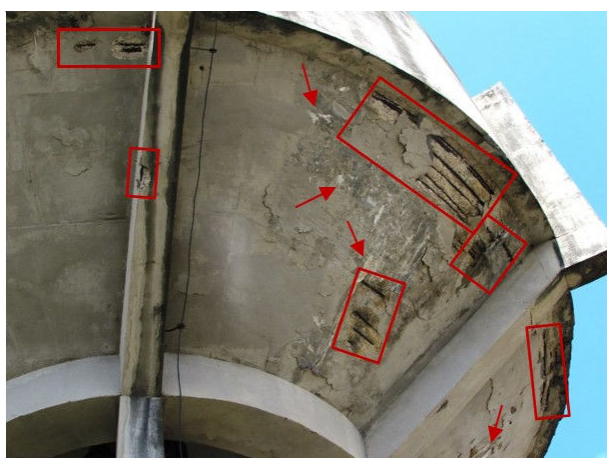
Vista da face externa da laje inferior da cuba (face sul) com manchas de umidade, em destaque eflorescências (setas) e corrosão da armadura (retângulos)
